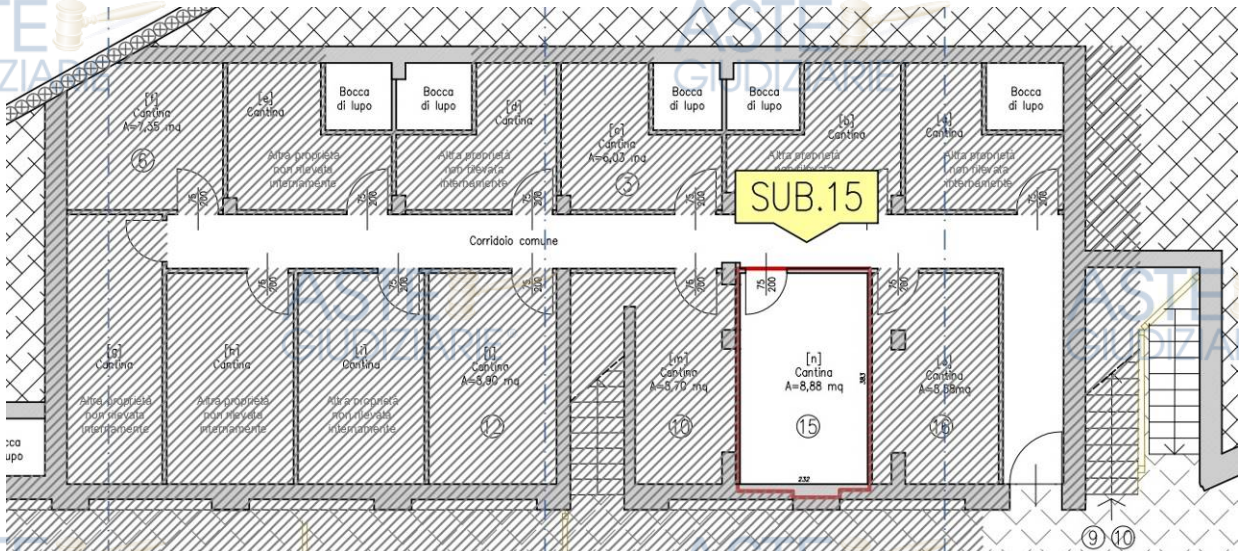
Estratto Tav.A03 S.C.I.A Prot. 15716 del 18.11.2025 – Piano interrato cantine
